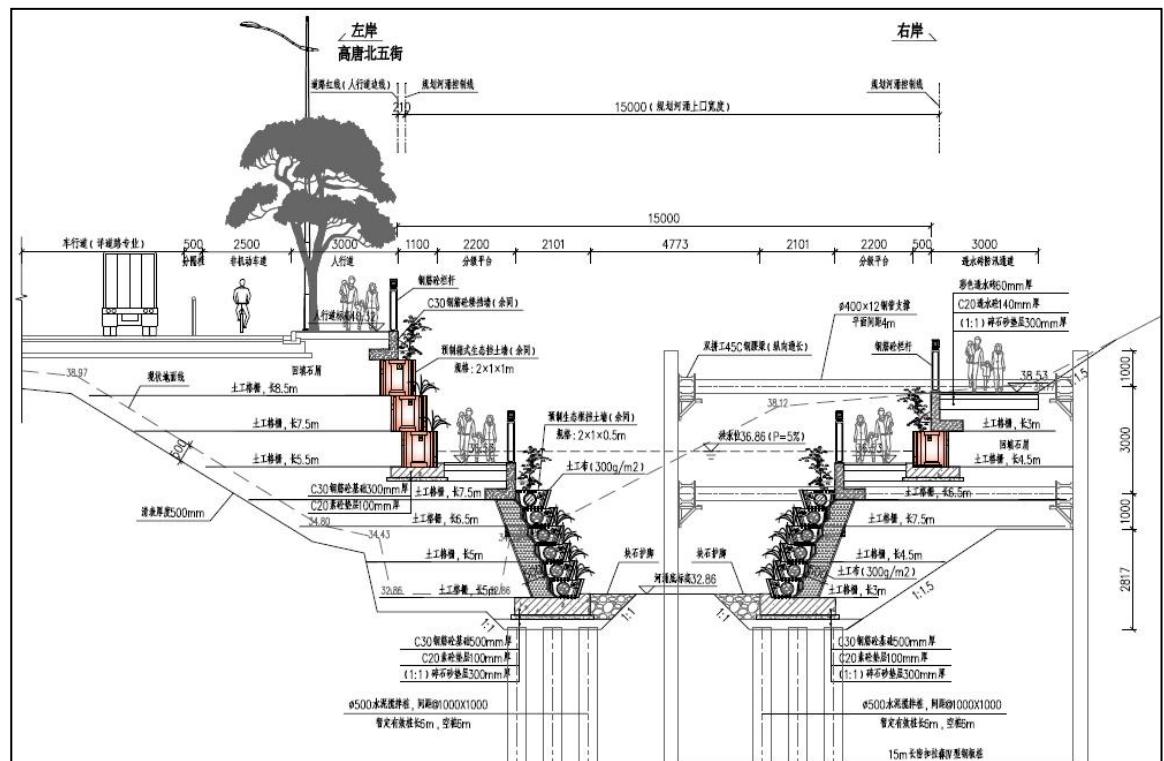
高唐北五街路堤合建横断面图（预制生态框+预制箱式生态挡土墙）
